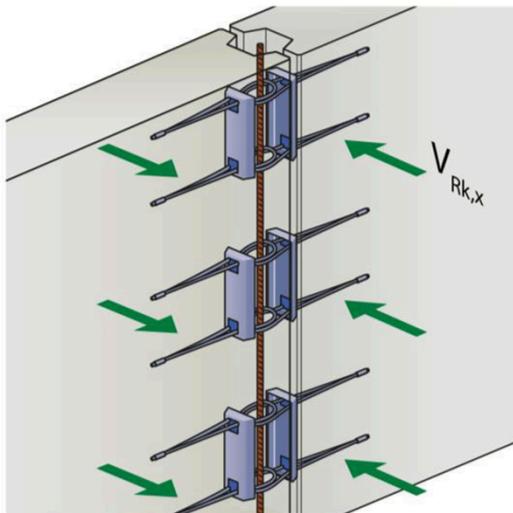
Beanspruchung unter Querlast 90° (senkrecht zu Fugenlängsrichtung und Wandebene)
